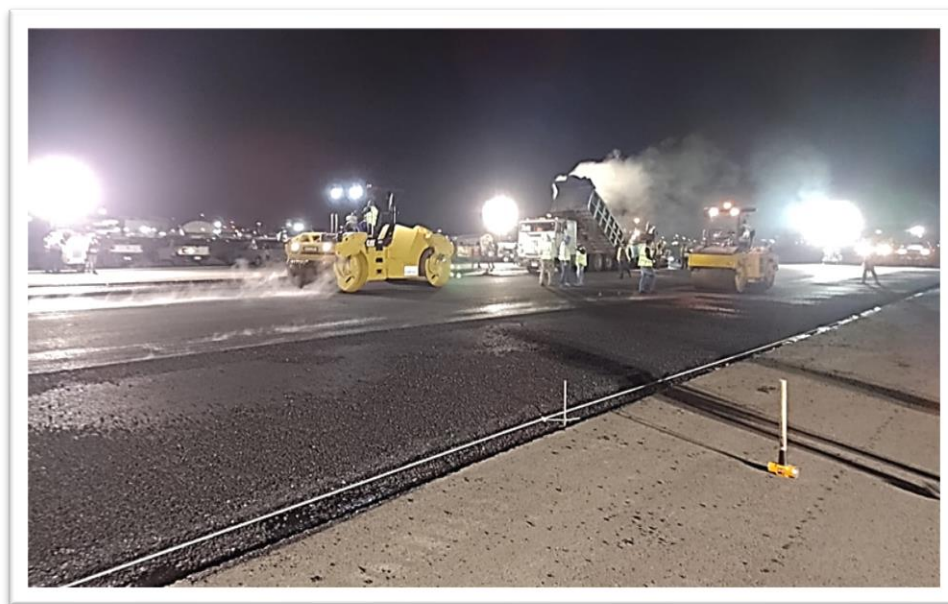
Tendido, tren de compactación de pavimento flexible (autoría propia)
